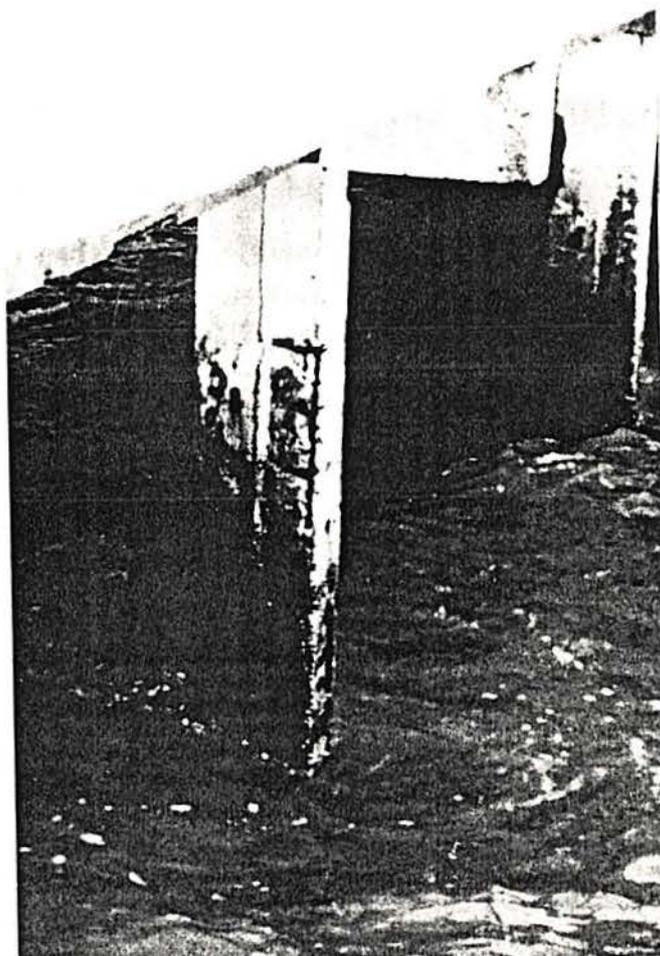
Corrosão de armaduras em pilares de um trapiche na zona de transição das marés
